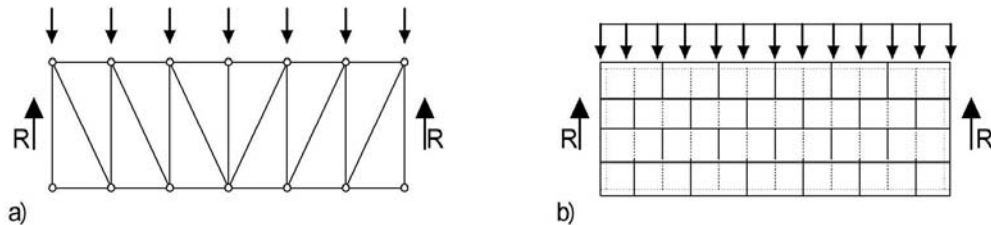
Skizzen typischer Aussteifungssysteme für Decken- und Dachkonstruktionen
